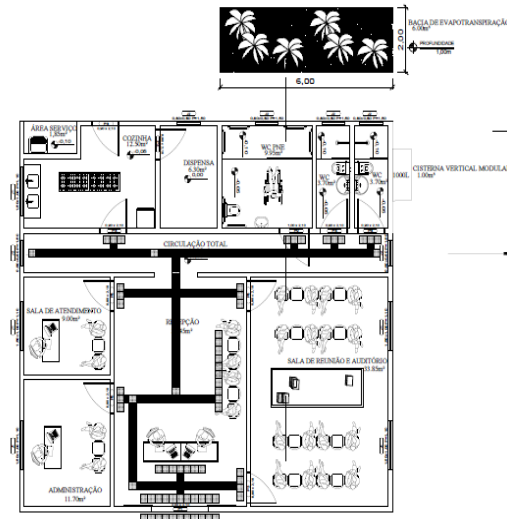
Planta da edificação bioconstrução Fonte: Autoria Própria (2018)
